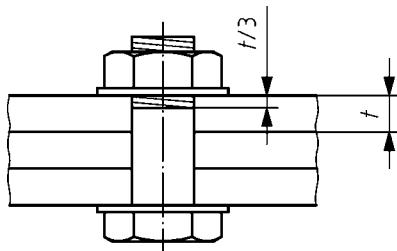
Gewindeanteil des Schraubenschaftes im auf Lochleibung beanspruchten Blech bei Passschrauben
